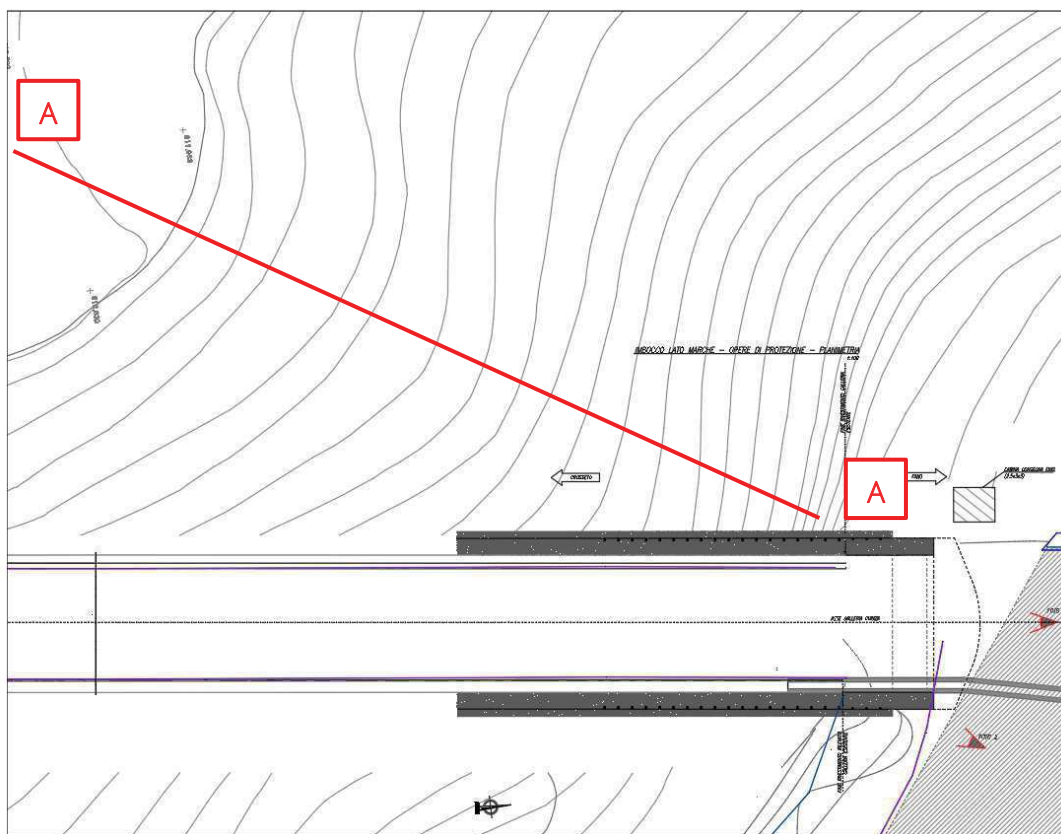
Sezione di verifica: traccia planimetrica.
